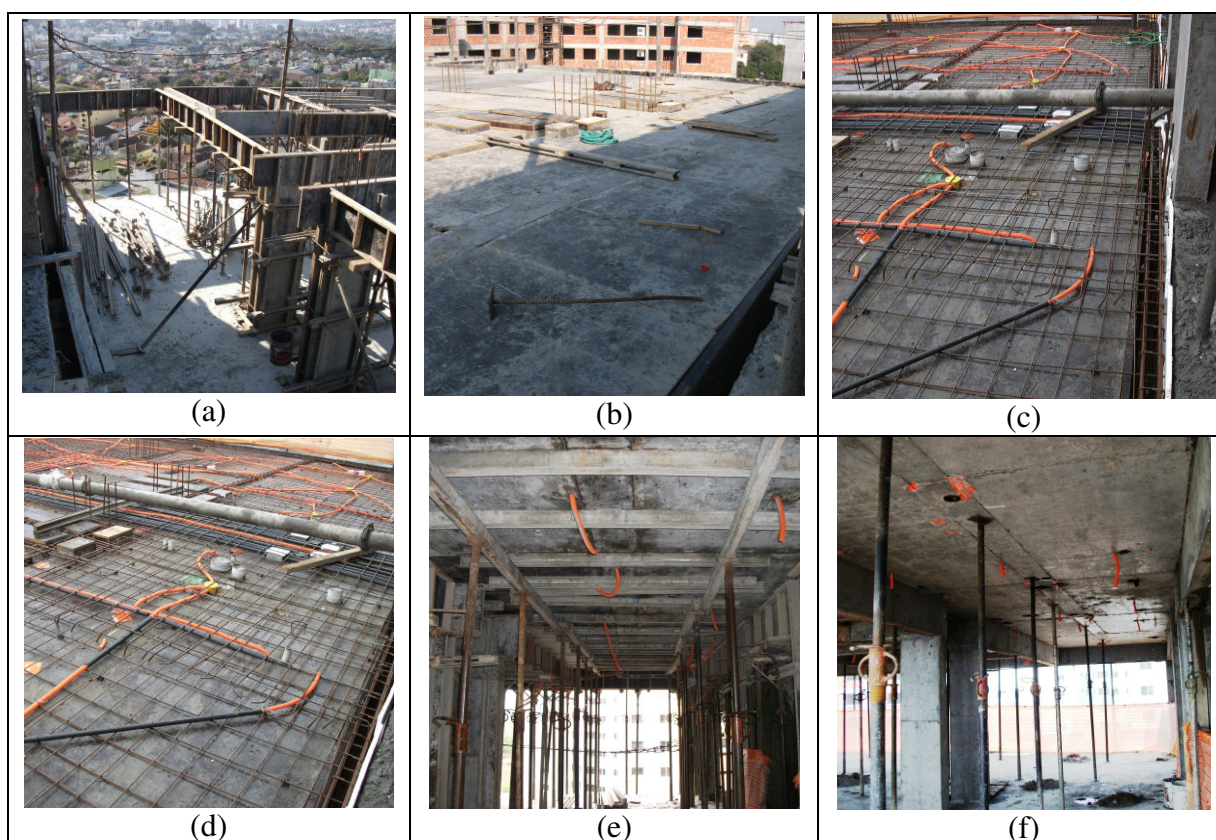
execução do 19º pavimento. (a) montagem das formas das vigas, (b) painéis da laje, (c) e (d) armadura da laje e embutidos, (e) escoramento da laje, (f) reescoramento da laje
